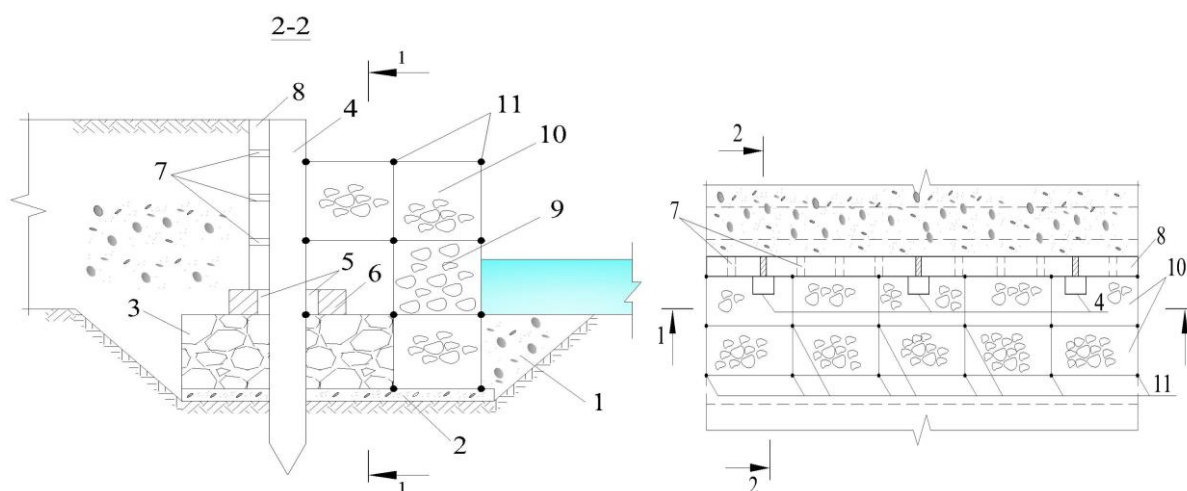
План и разрезы берегоукрепительные сооружения: русло реки – 1, слой бетонной подготовки – 2; каменная наброска -3; железобетонная опора (свая) – 4; отверстия -5; бетонная плита - 6; отверстия - 7; железобетонная плита - 8; камень - 9, металлический ящик - 10; узлы – 11.
